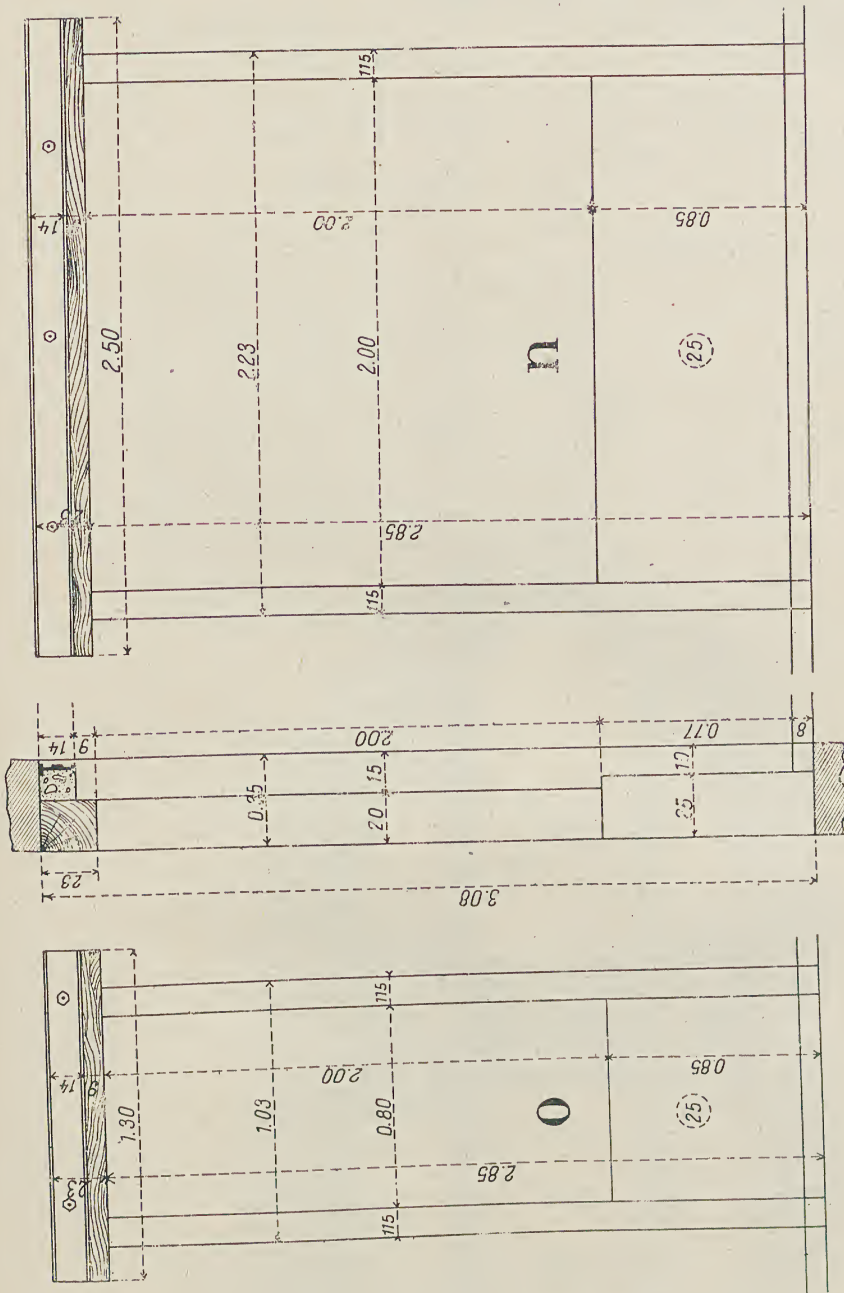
à 373. — Baies o et n ; élévation intérieure, coupe et plan.
